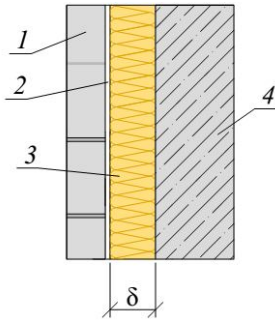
Стена ж/б, утепленная, с облицовкой кирпичом: 1 – облицовочный кирпич; 2 – 20 мм вентилируемого слоя; 3 – тепловая изоляция; 4 – ж/б стена
